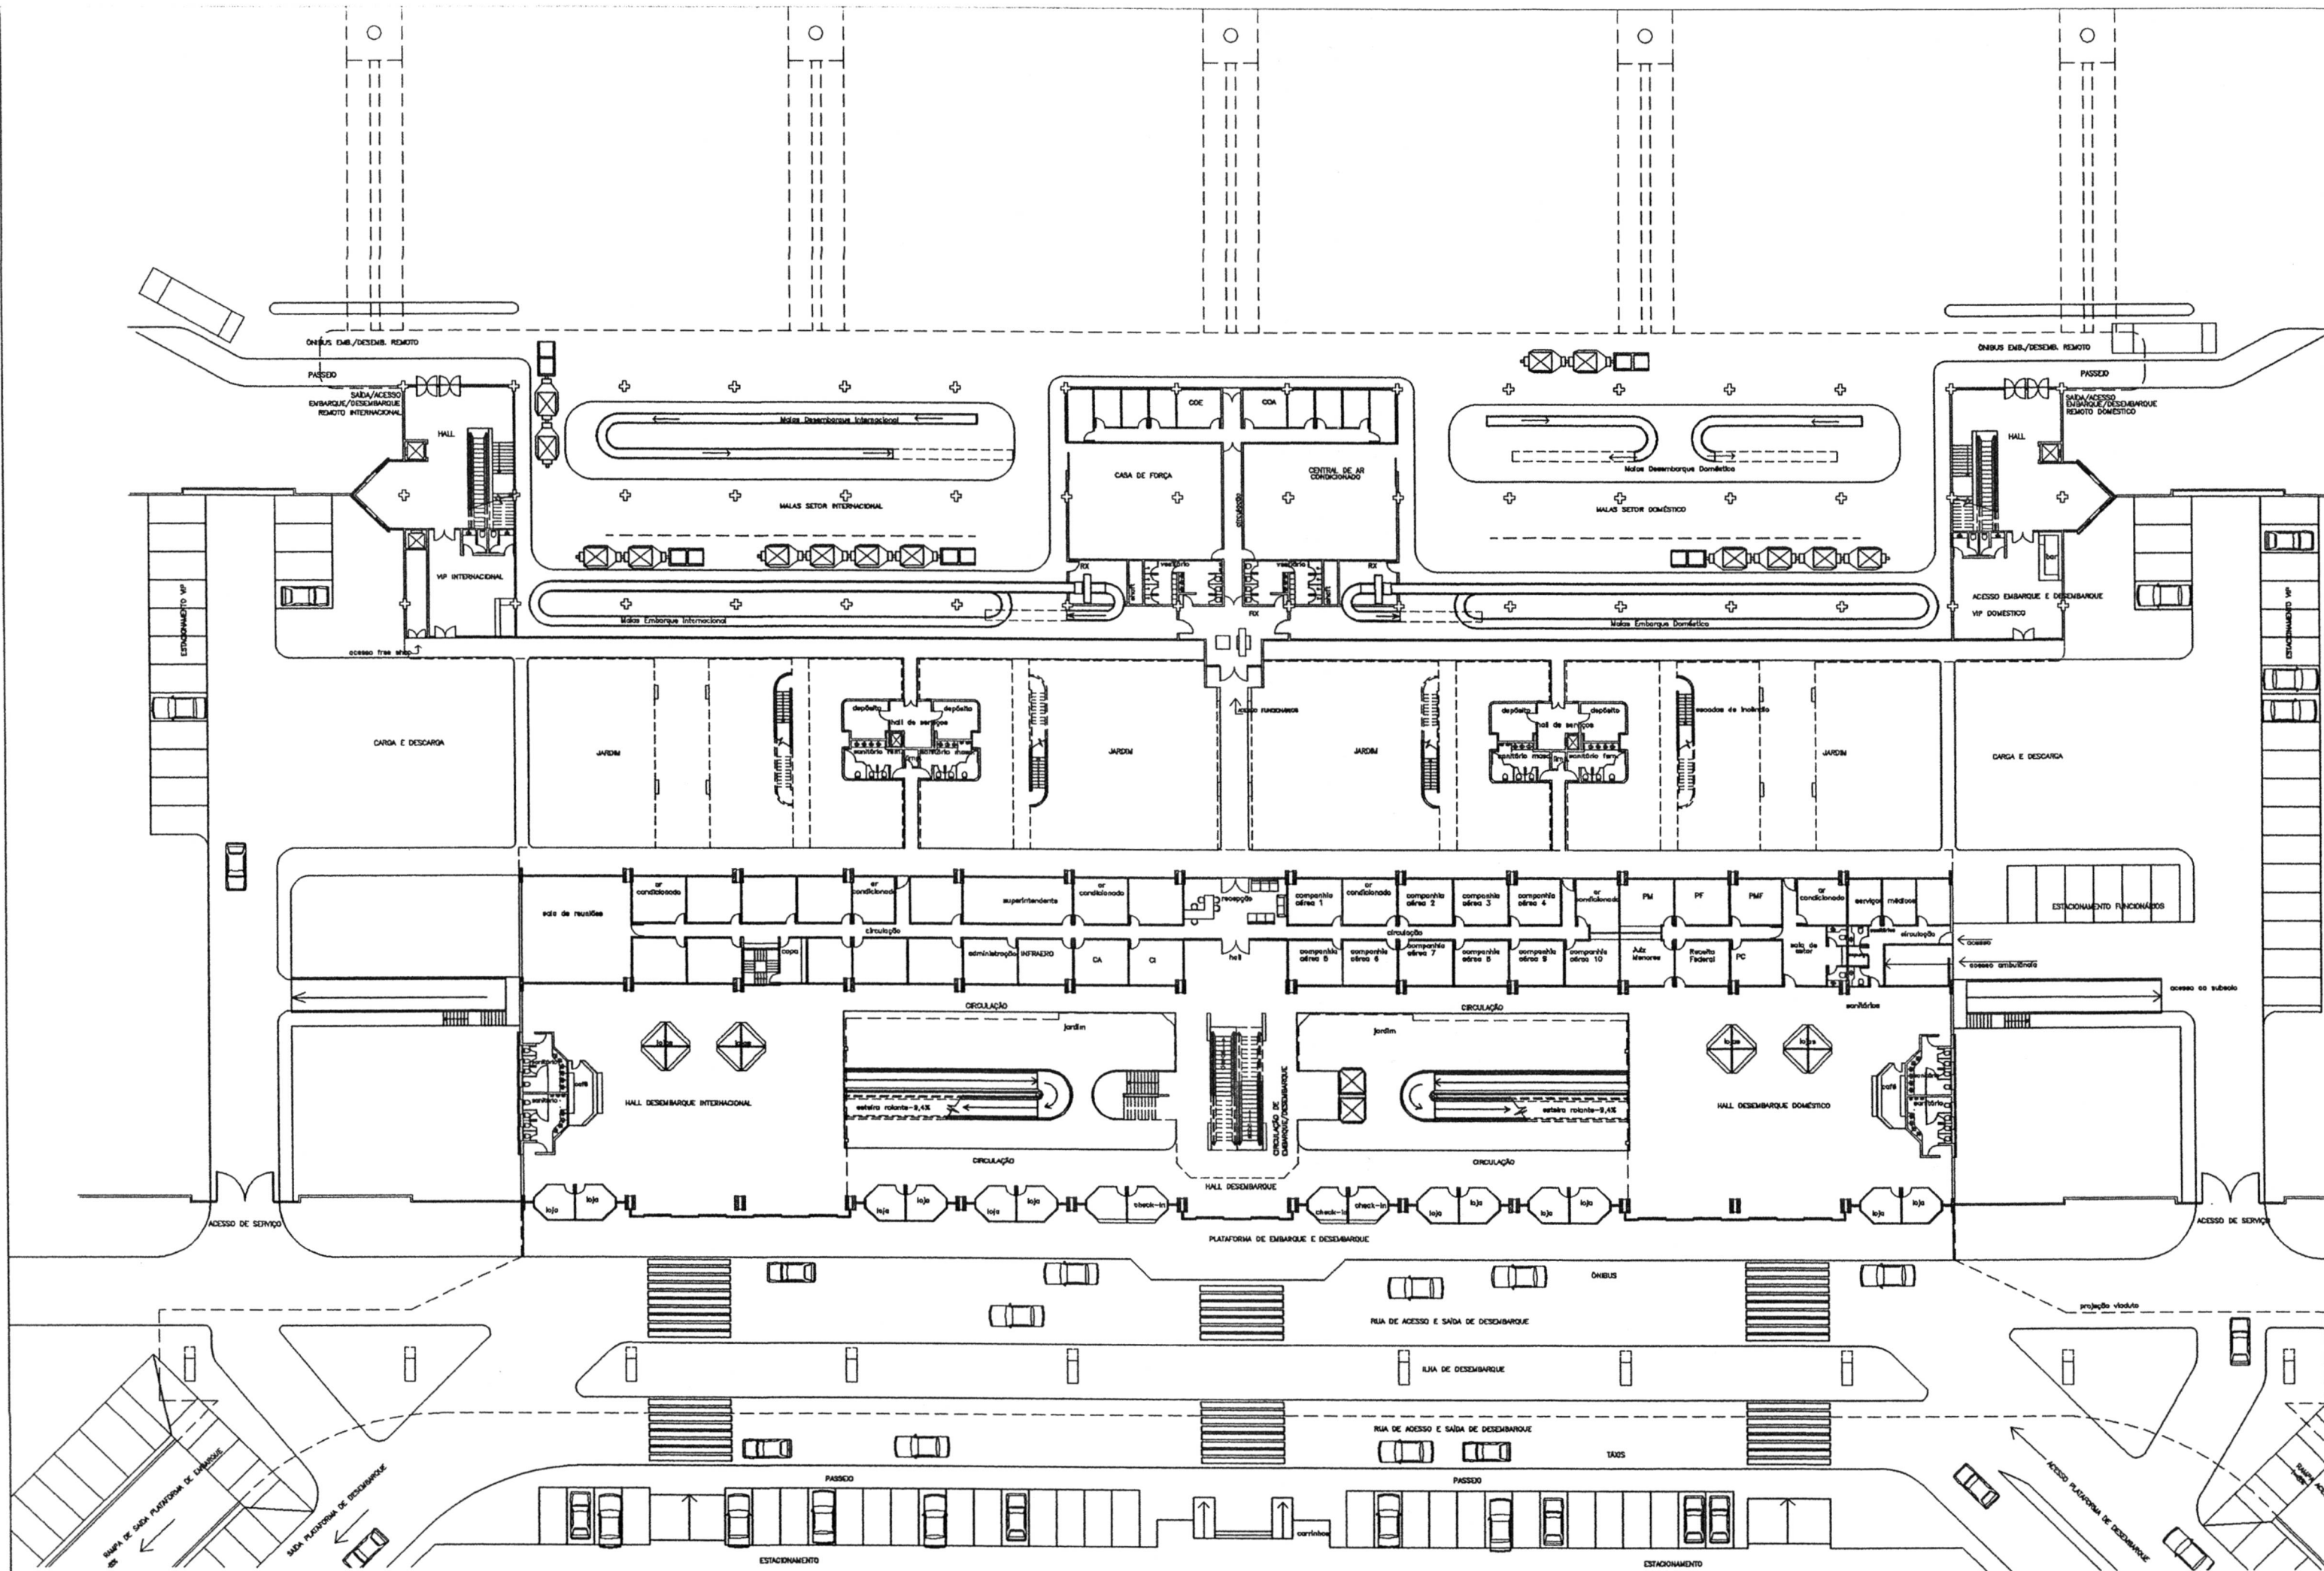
Planta Baixa Nível Térreo - esc. 1:500.
